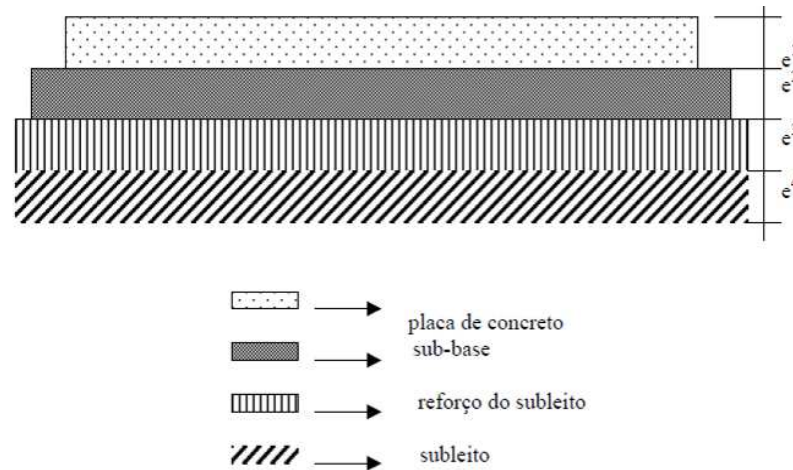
Seção transversal típica dos pavimentos rígidos (SENÇO, 1997).
